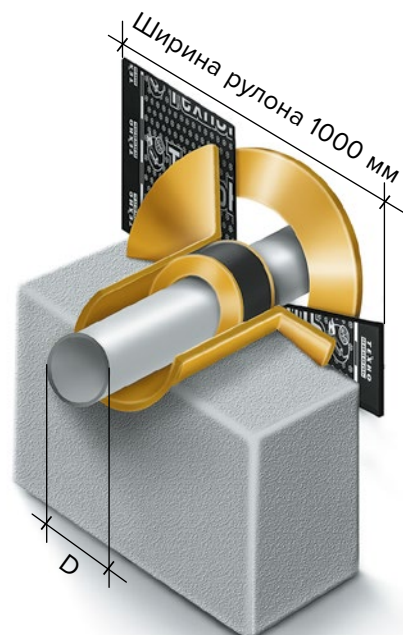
Раскладка рулона Техноэласт Фундамент ТЕРРА в зоне трубной проходки
